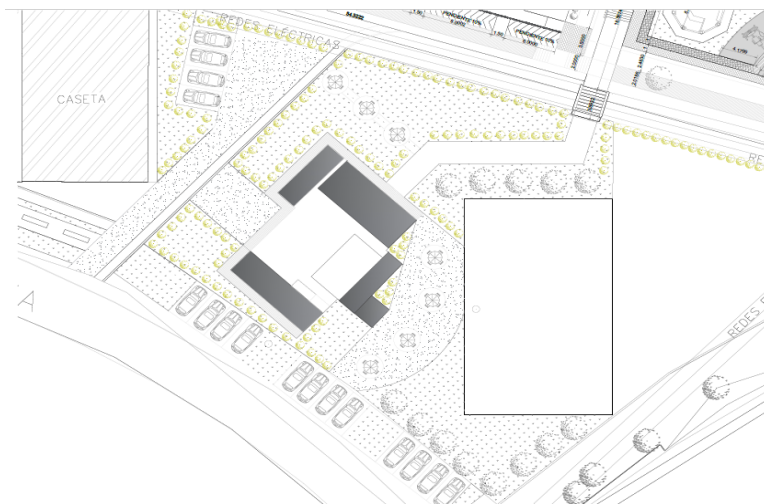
Vista en Planta-proyecto SACUDETE.
